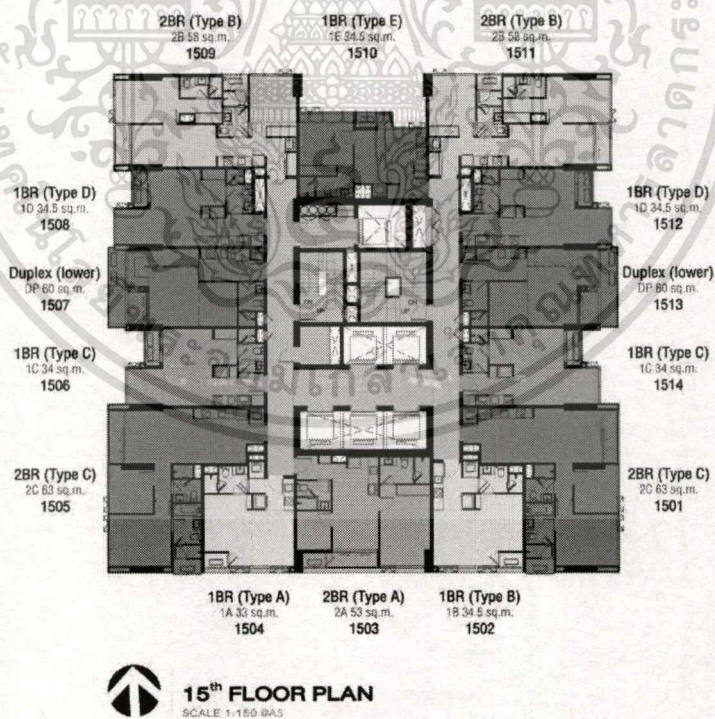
แสดงผังบริเวณโครงการ ไฮด์ สุขุมวิท 11
